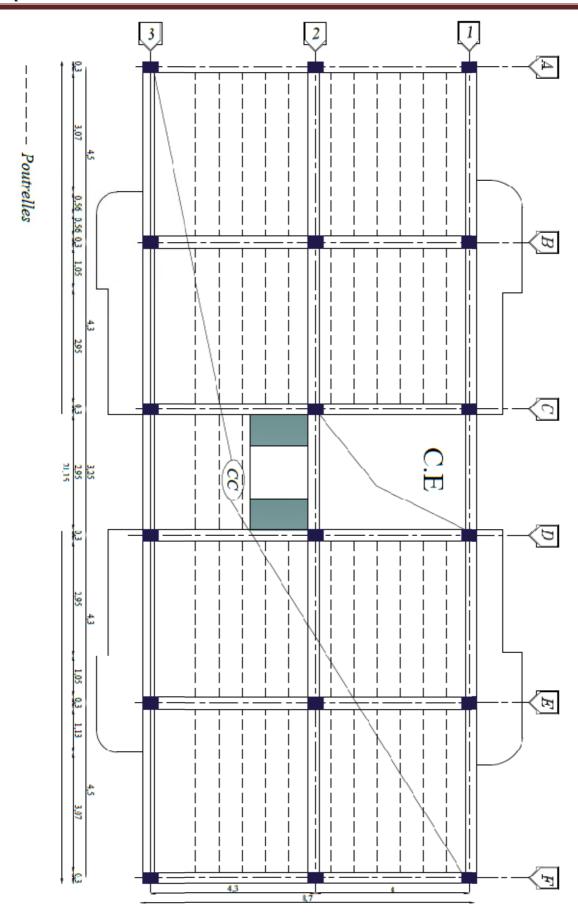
Sens de disposition des poutrelles à tous les niveaux
